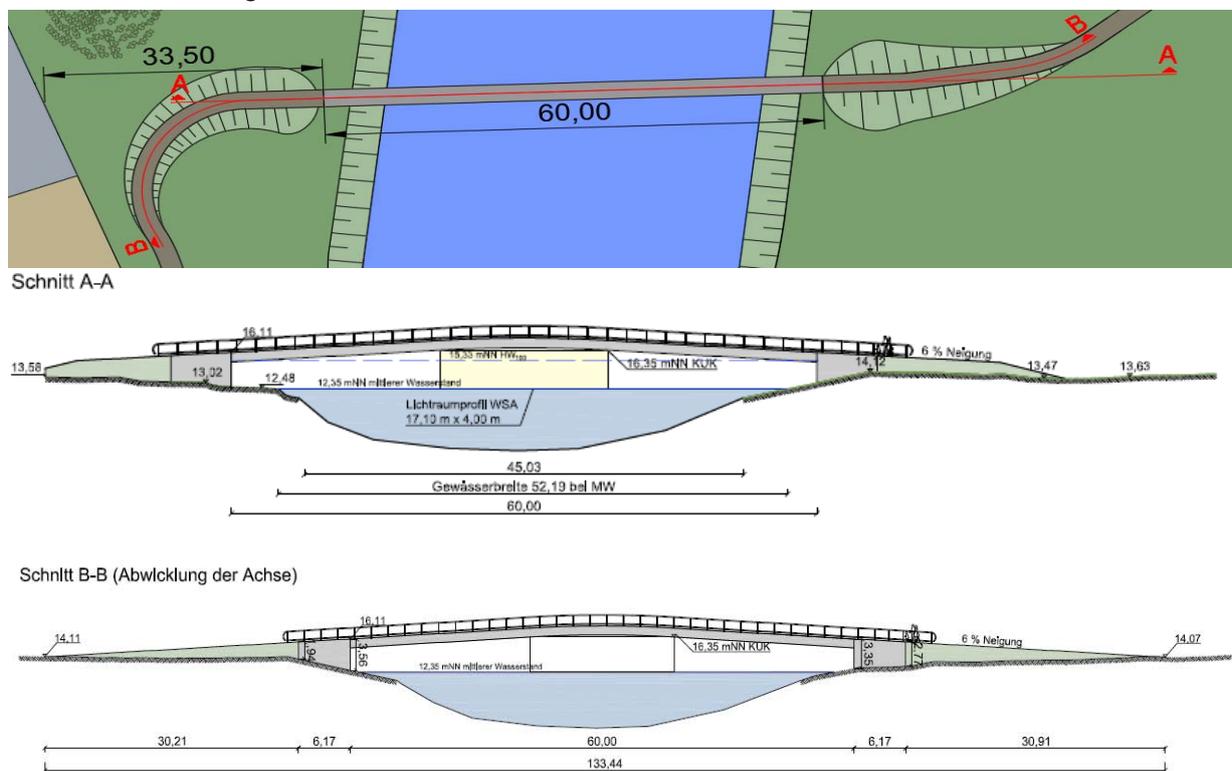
Lageplan und Schnitte (Quelle: LIG Emsland)
